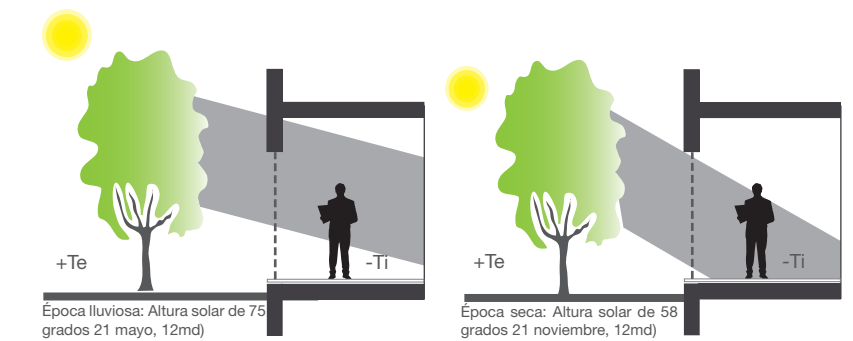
Uso de vegetación para protección solar en fachadas y ventanas de orientación norte (elaborado por autores).
